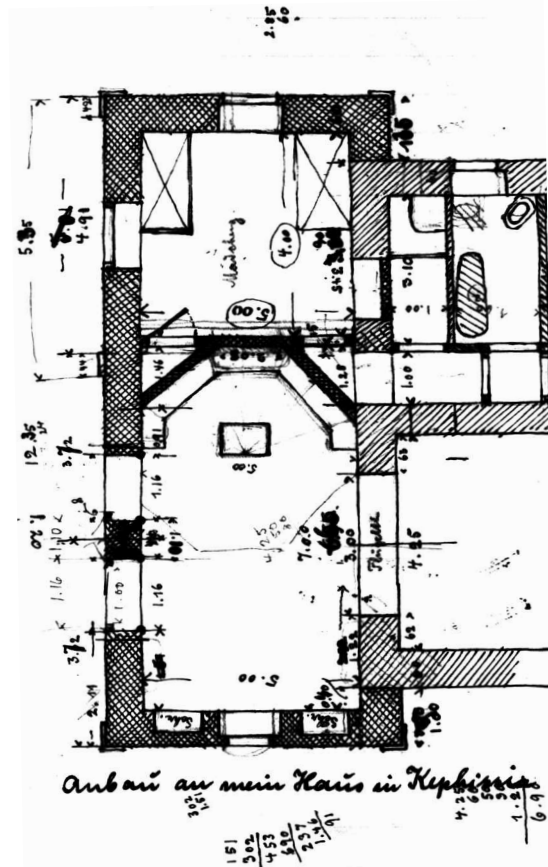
Erweiterung des Sommerhauses, Grundriss
